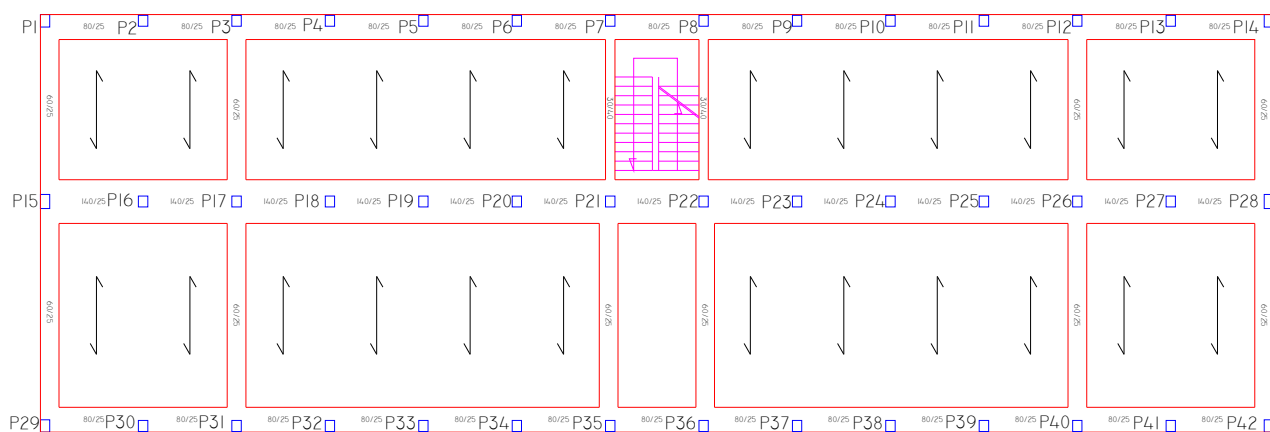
Carpenteria piano tipo utilizzata nelle verifiche del 2003
